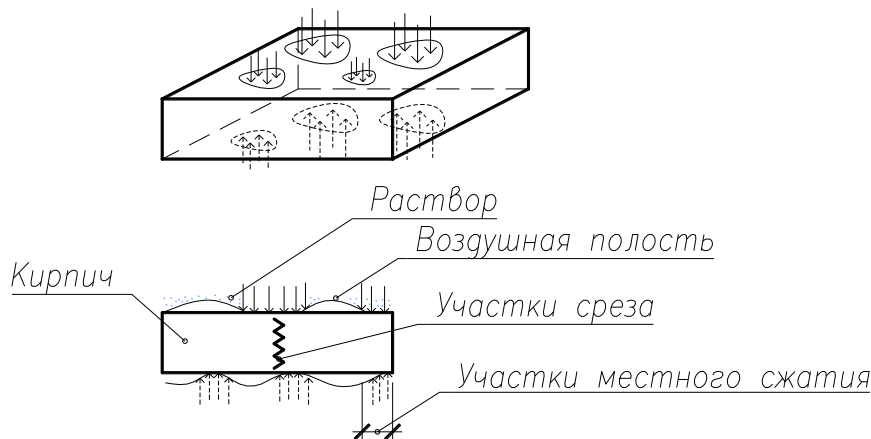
Работа кирпича или камня в кладке под нагрузкой
